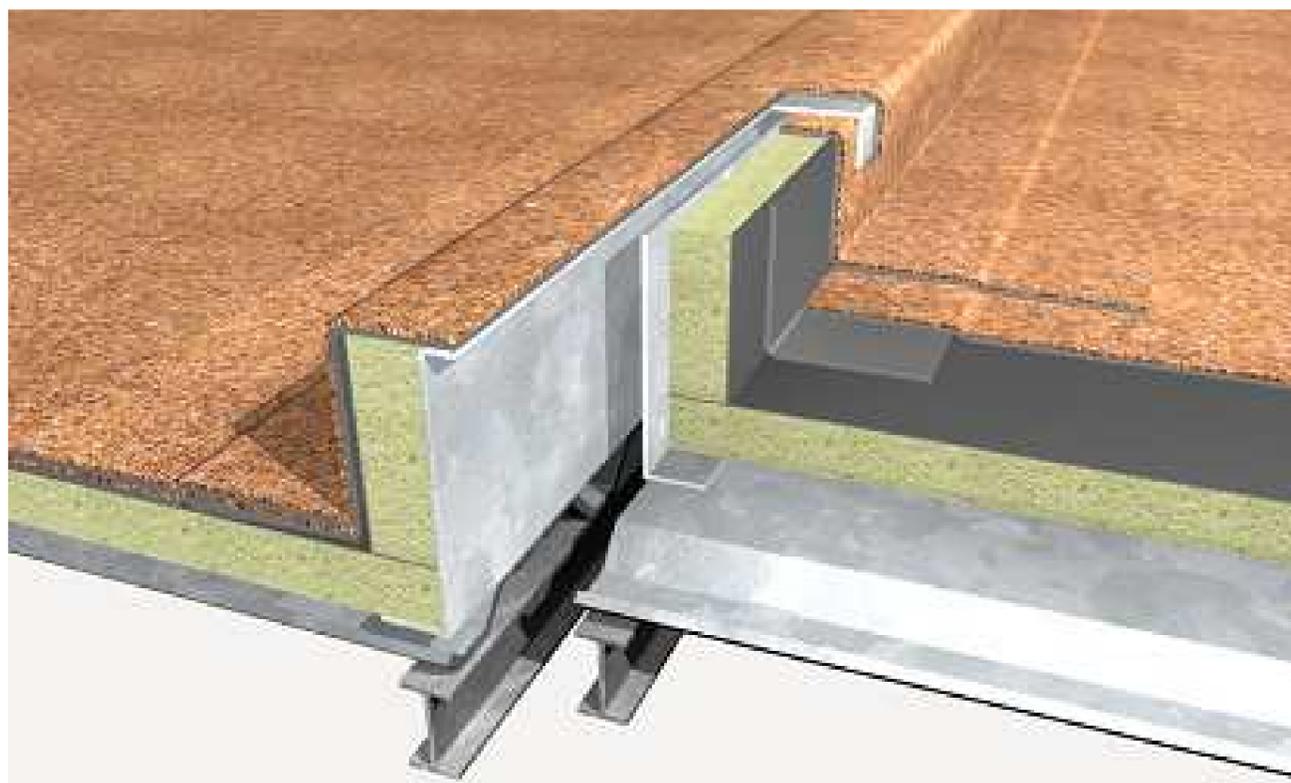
Detalle cubierta Deck. Fuente: Incoperfil
